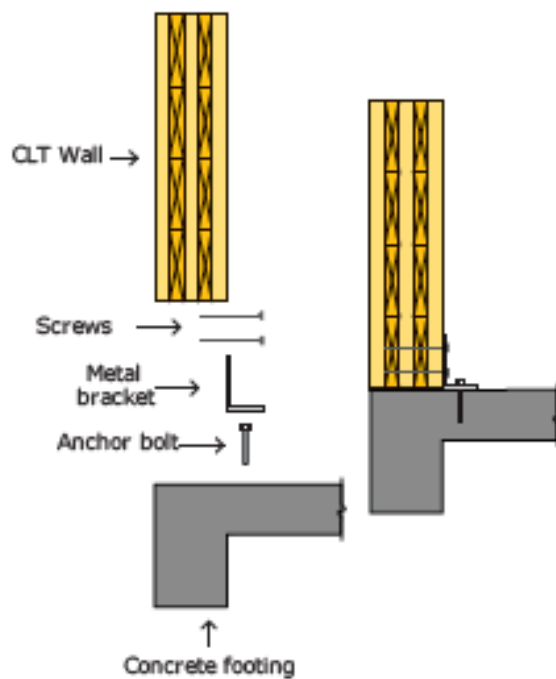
Unión muro de CLT - Fundación a través de conector metálico. (FPInnovations, 2011).
